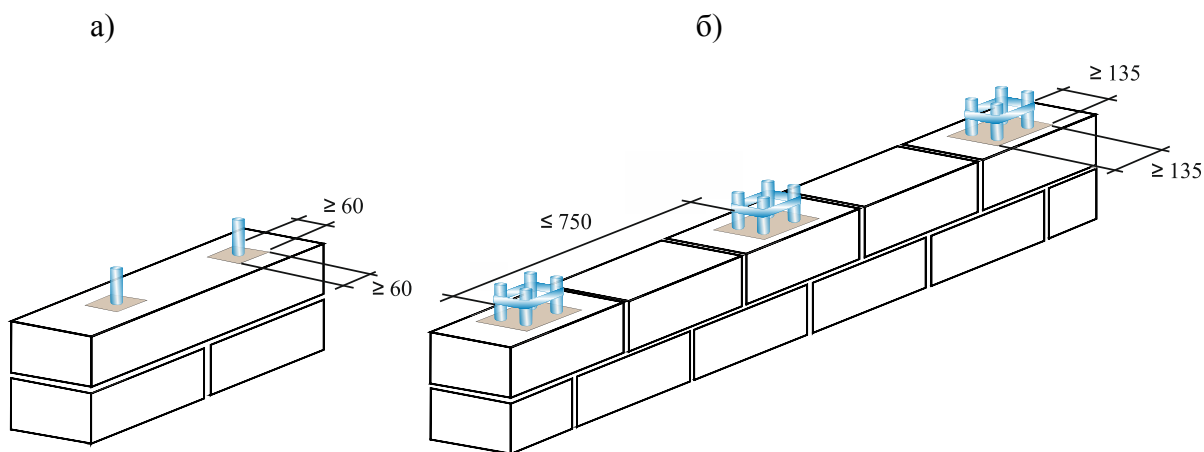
Расположение вертикальных арматурных стержней в заполняемых бетоном каналах пустотных каменных блоков [10]
